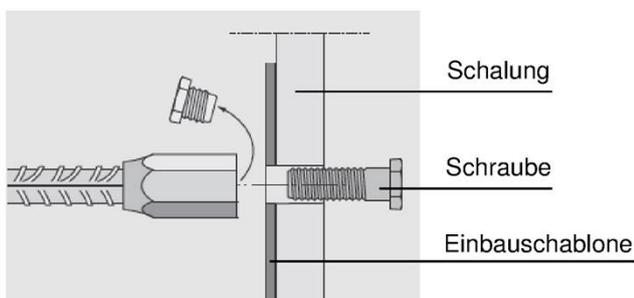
Montageprinzip für oberflächenbündige Anschlussebene im Beton: Einbauschablone liegt auf der Schalung
